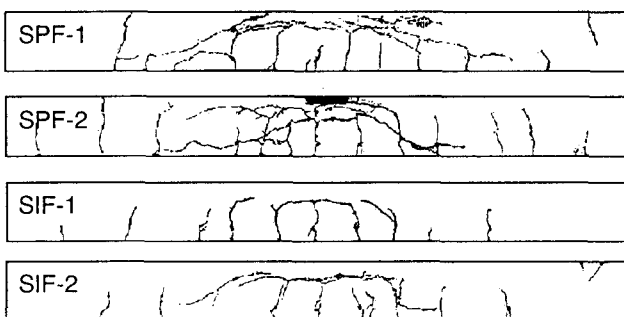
切断面のひび割れ発生状況(試験終了後)
